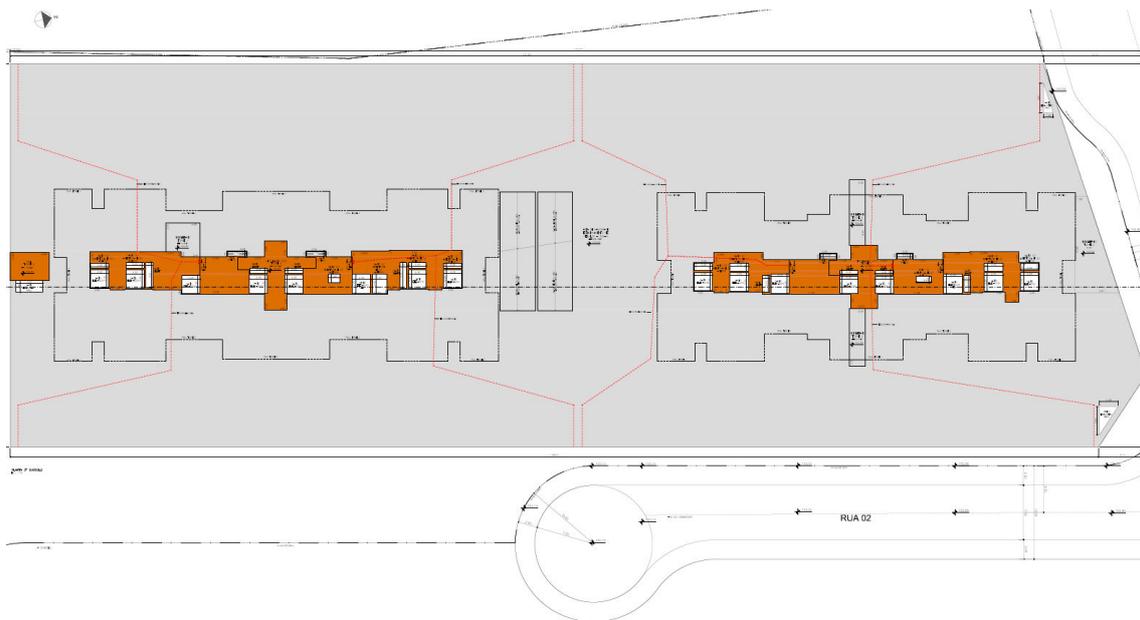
Planta do 3º Subsolo torres 1 e 2 do setor B1.
